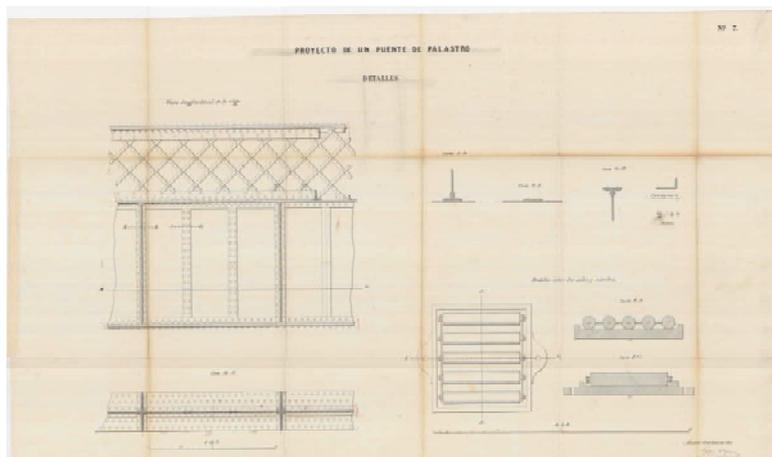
[España] Ministerio de Cultura y Deporte. Archivo General de la Administración, Signatura 24-02469, Plano nº 7 de detalles de la viga y rodillos sobre las pilas y estribos del puente de palastro (Ingeniero Eugenio Barrón, Madrid, 10 de julio de 1859).
